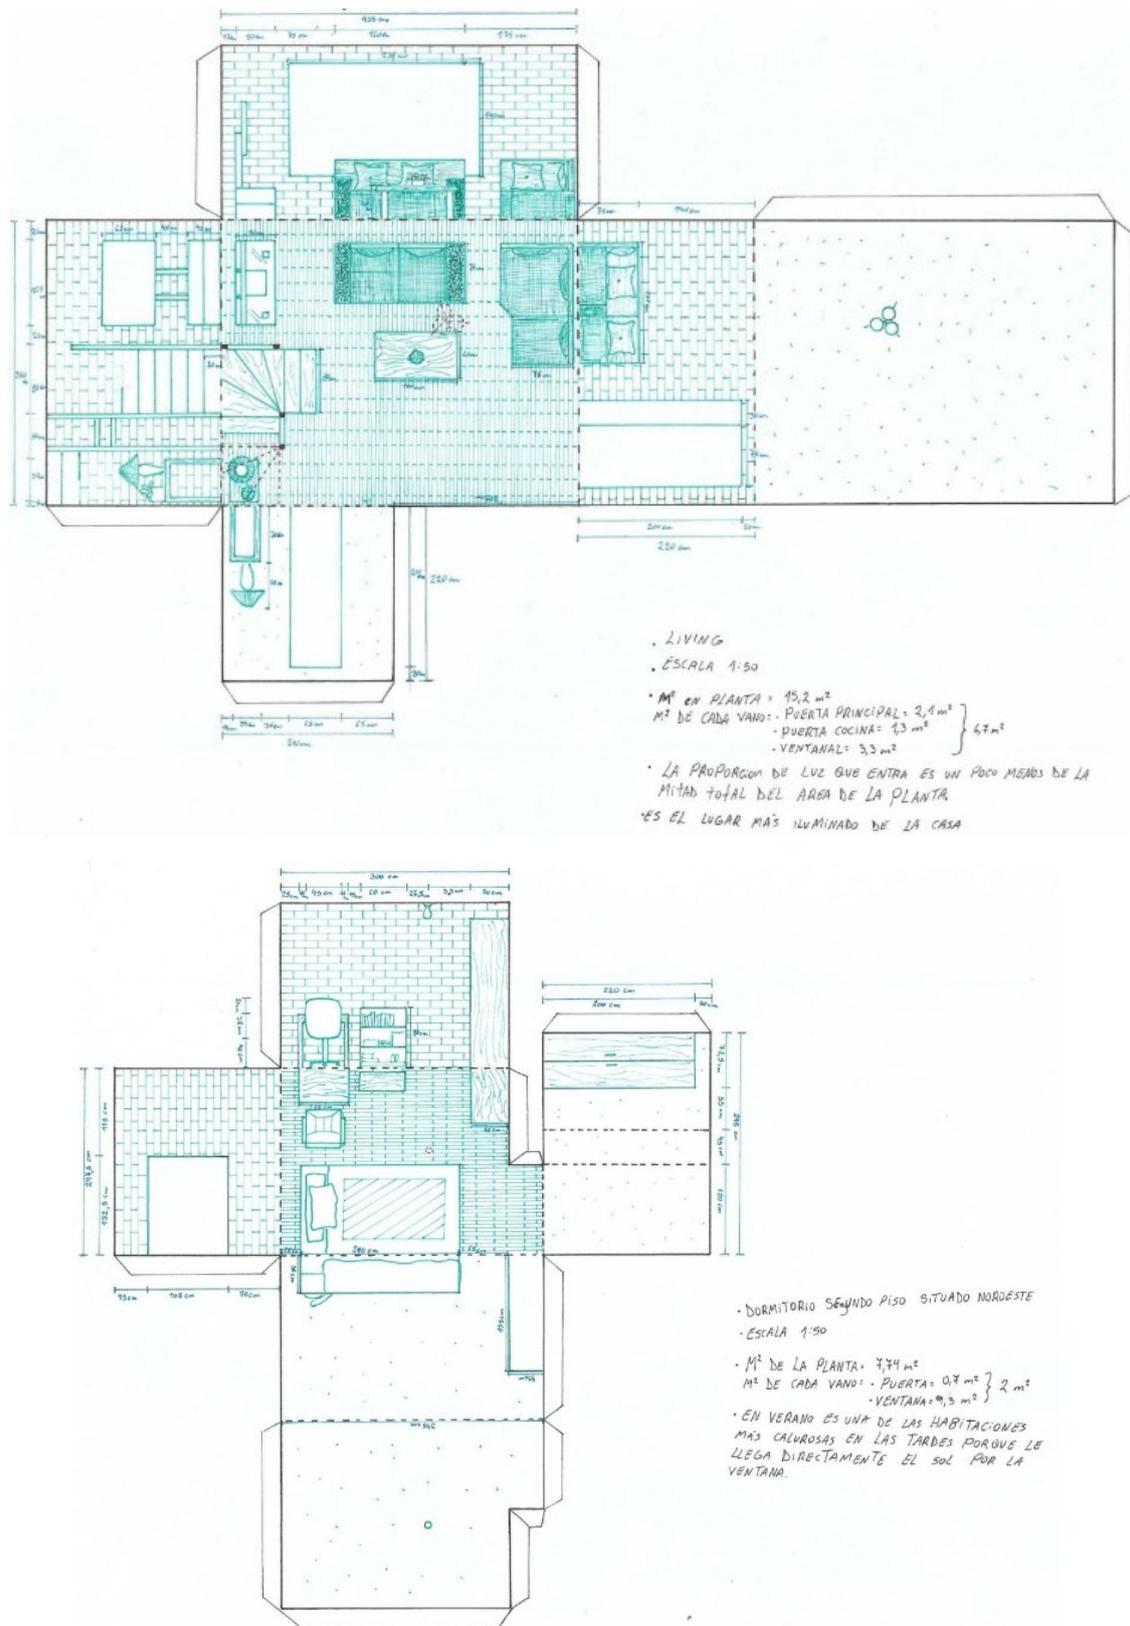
Parte 2: planimetría desplegada. Fuente: alumna Francisca Fuentes (2020)
